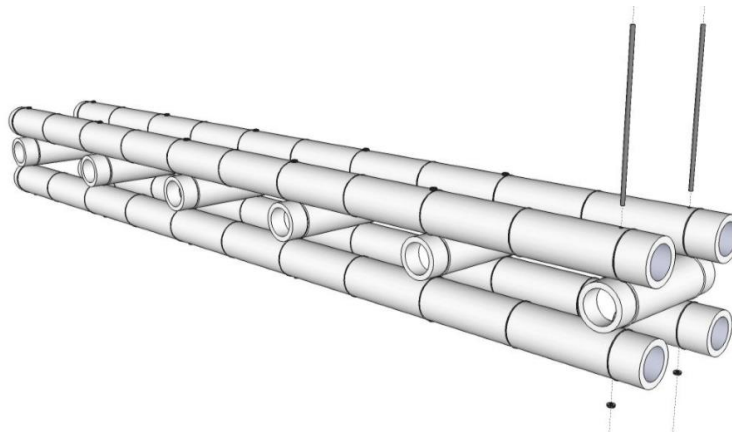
Vigas y Entrepisos. Viga Compuesta Tipo B
